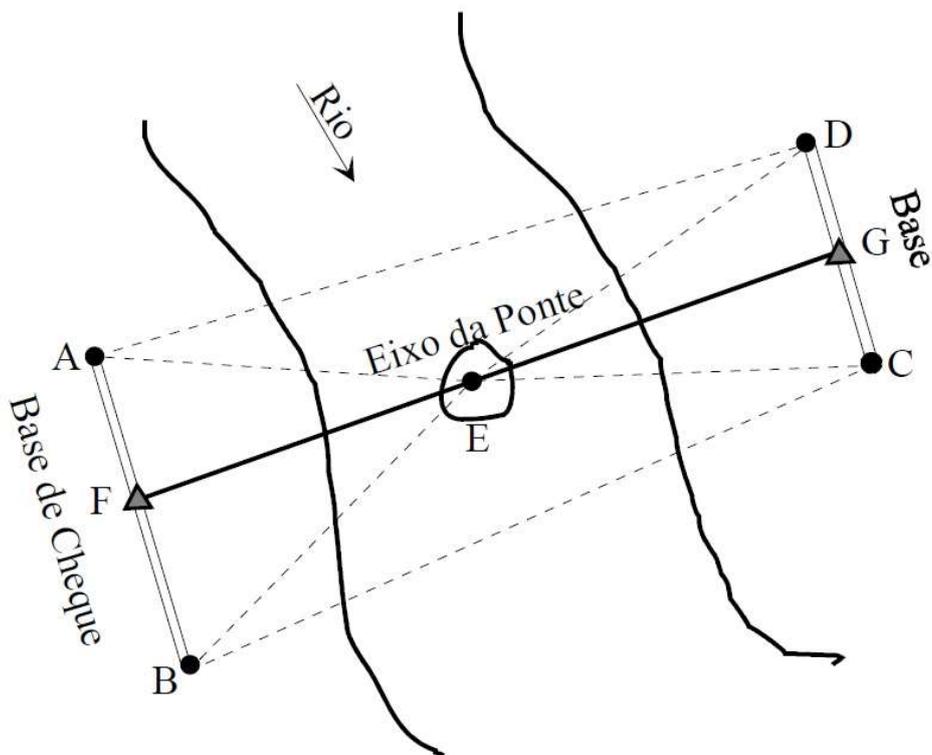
Locação do eixo de uma ponte com ponto central de apoio.
